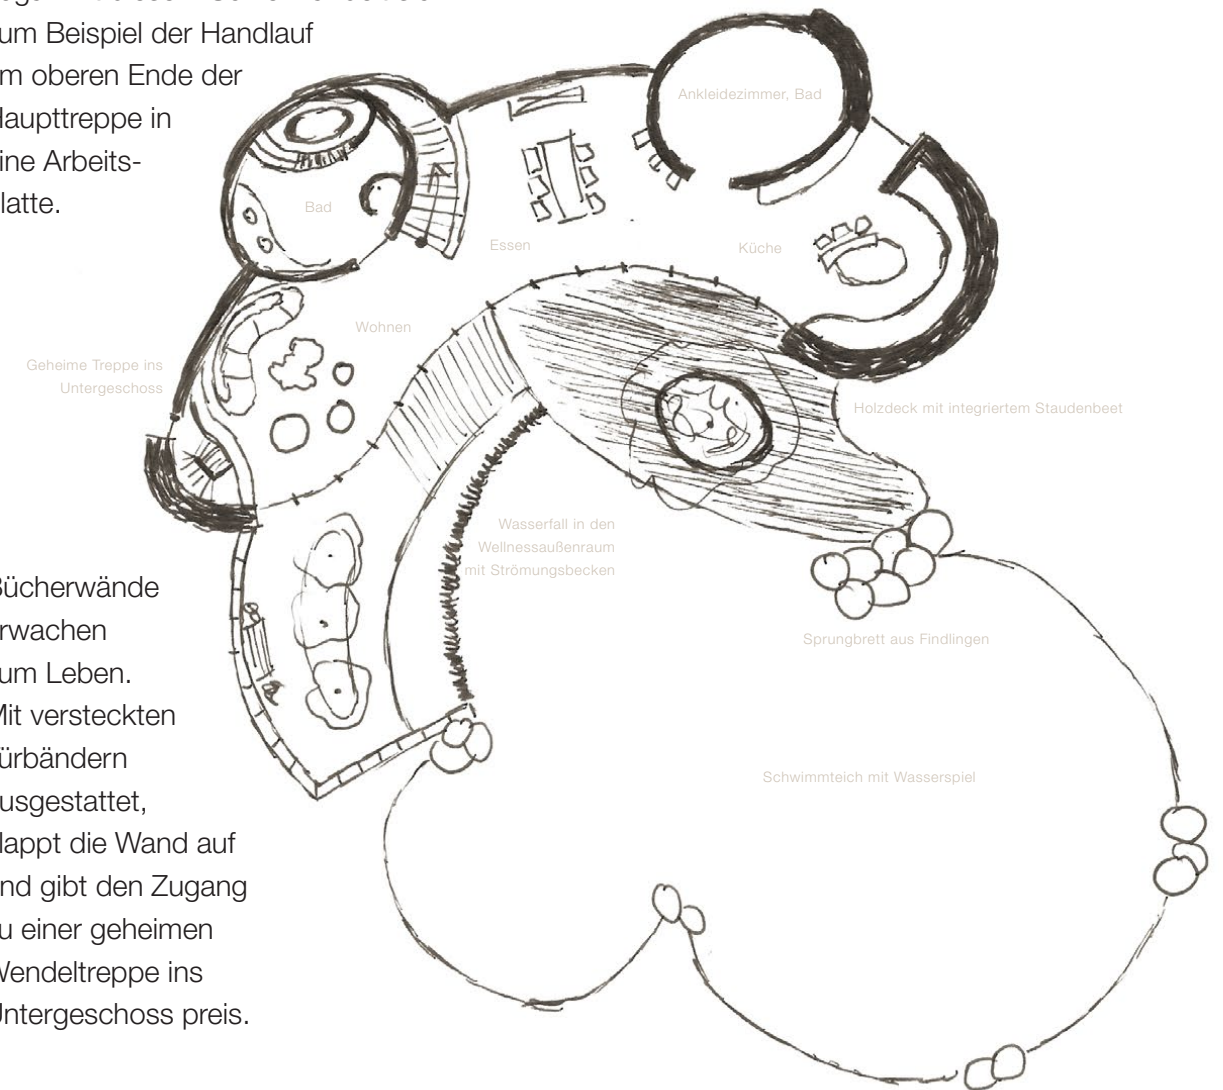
| Skizze Wohnhaus, Erdgeschoss
